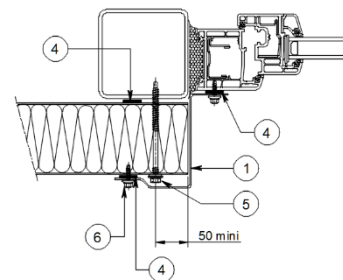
Baie en pose verticale (hauteur maximale de baies de 20 m)
